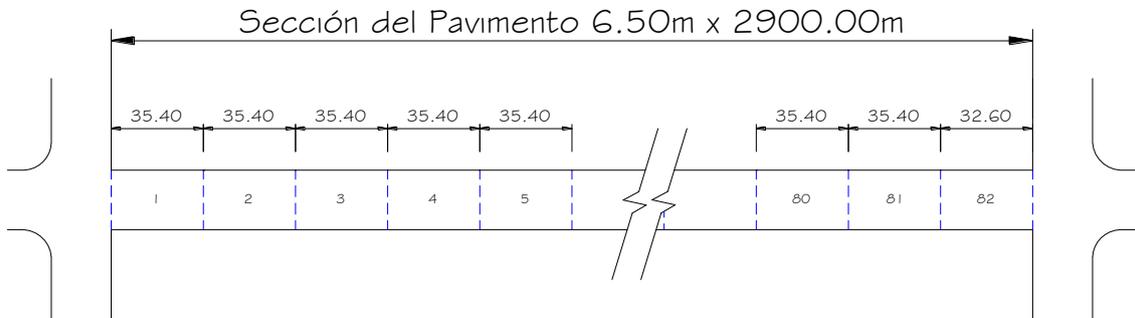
Ejemplo de la división en unidades de muestra para un pavimento asfáltico
